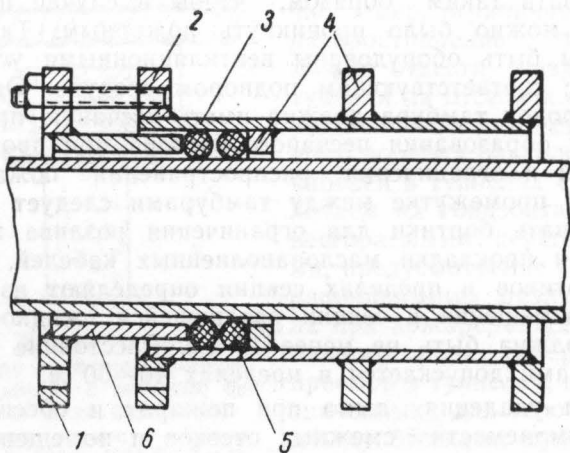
Защита отверстия при пропуске трубопровода через стену с помощью стального сварного сальника
